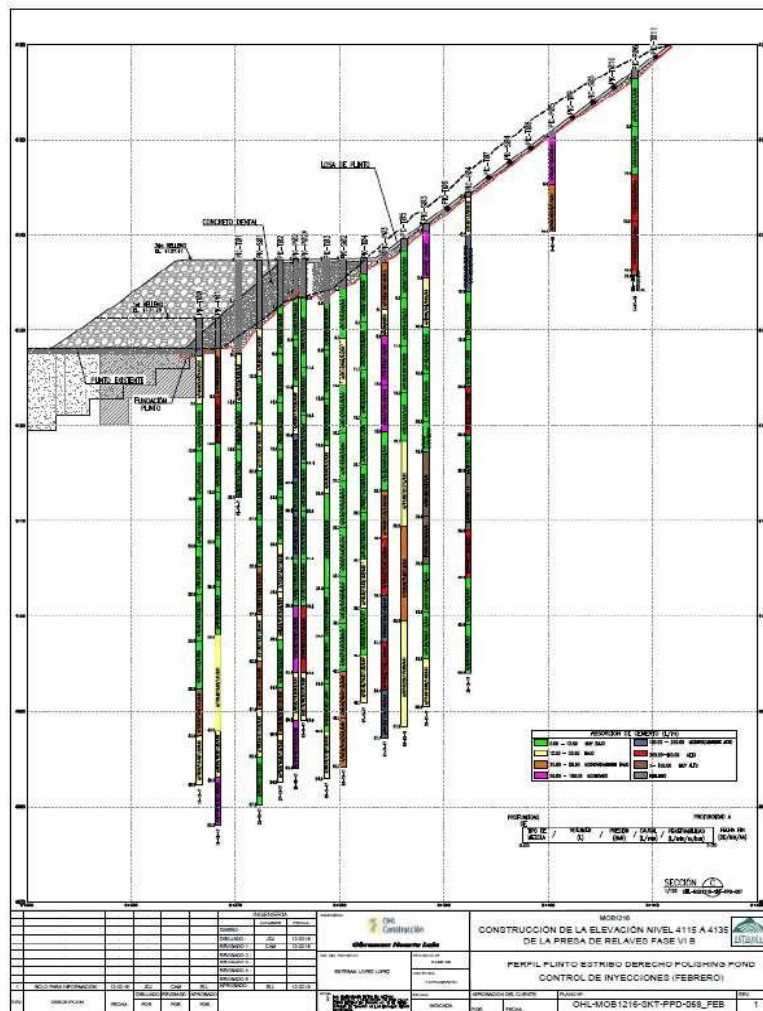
Estribo derecho vista2, distribución de cortina de inyecciones - planta
